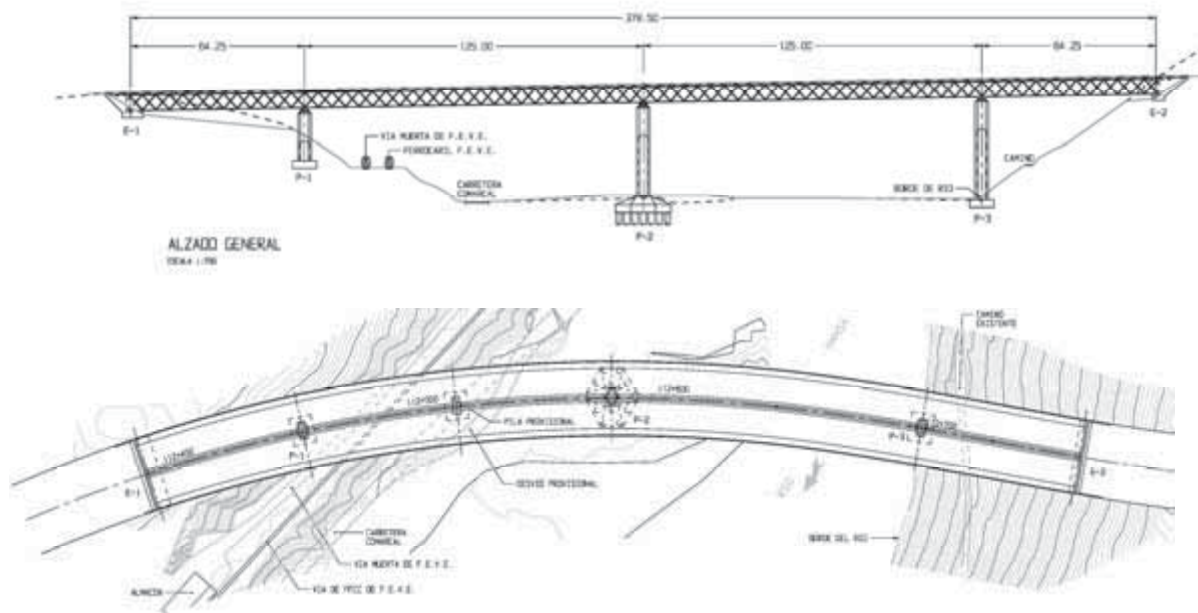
Le viaduc de Tina Menor, élévation et vue en plan [56]
